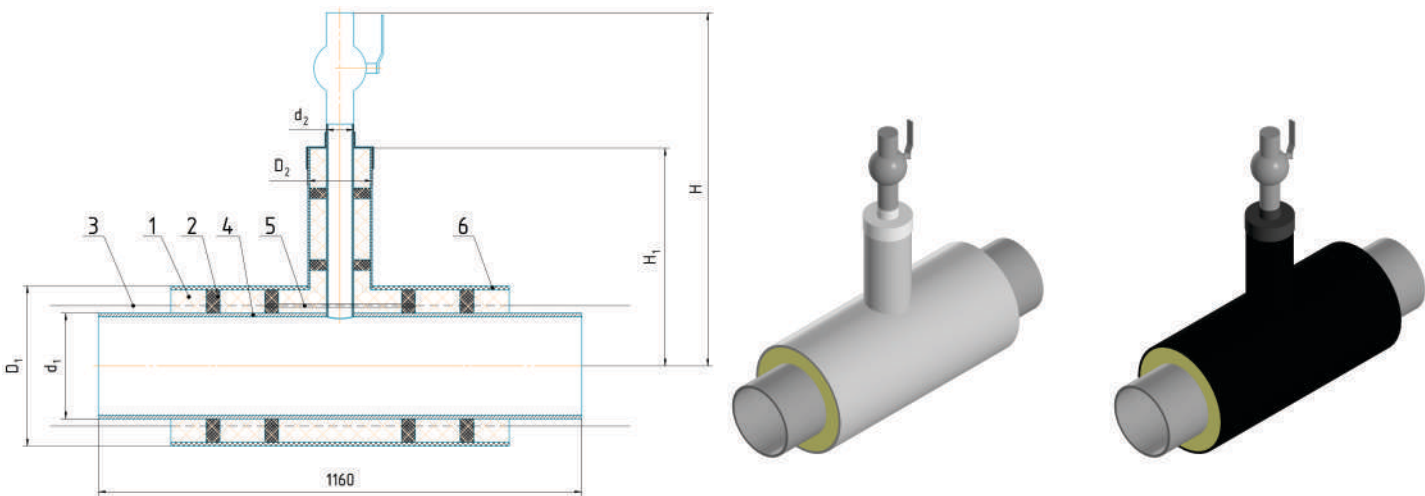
Конструкция тройника с шаровым краном воздушника в ППУ изоляции
